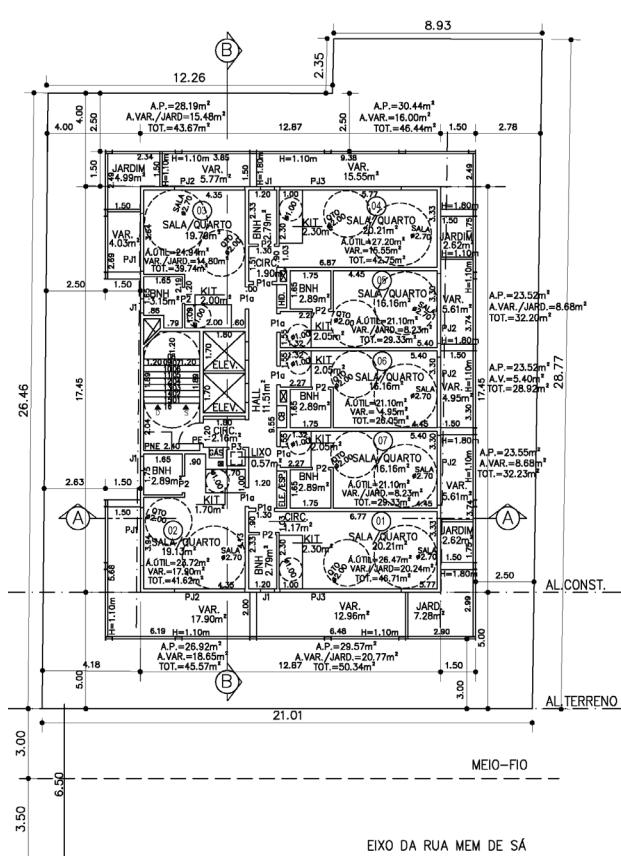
Pavt. Tipo – 7º Pavimento – Fonte: Projeto Legal
